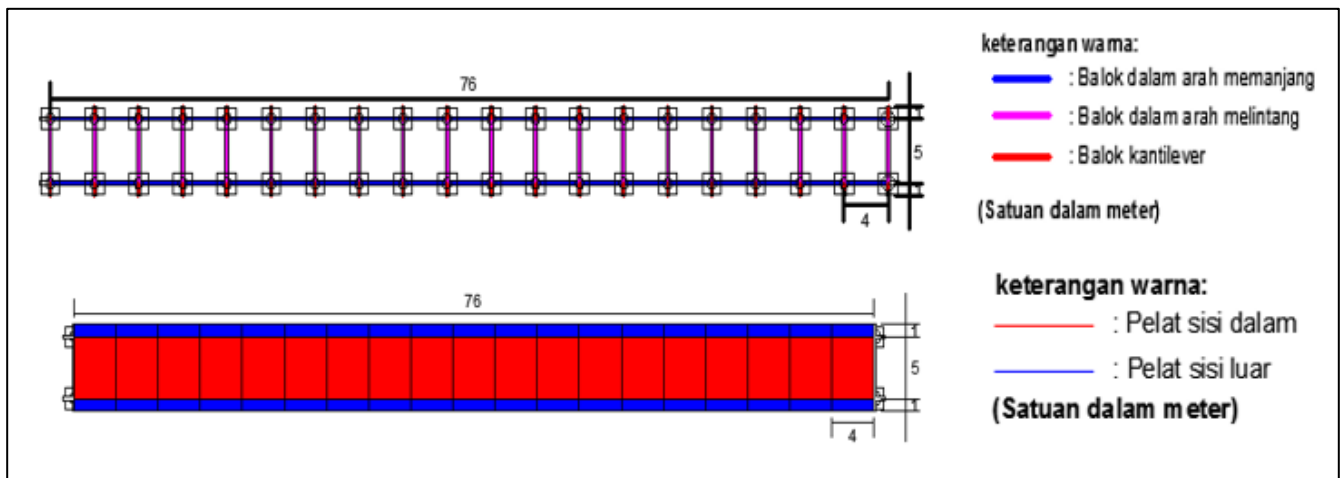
Layout Rencana Dermaga tipe *Dolphin
